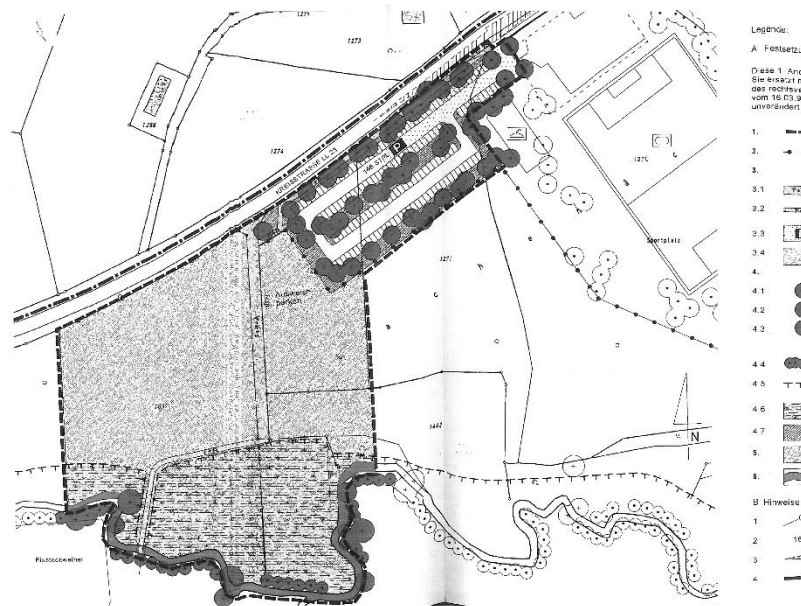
Planzeichnung 1. Änderung des B-Plans „Sportgelände“ (04.02.2000), ohne Maßstab
